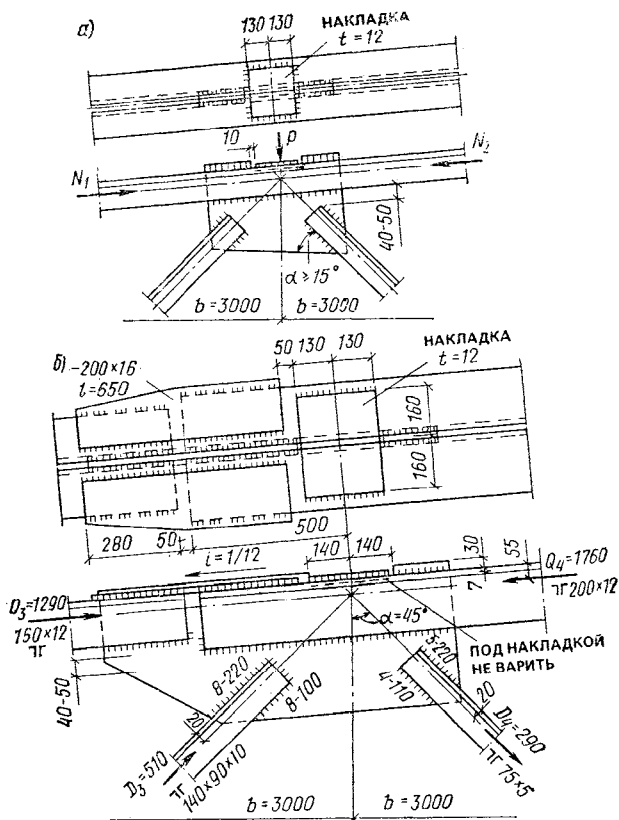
Узлы фермы с усилением верхнего пояса накладками
